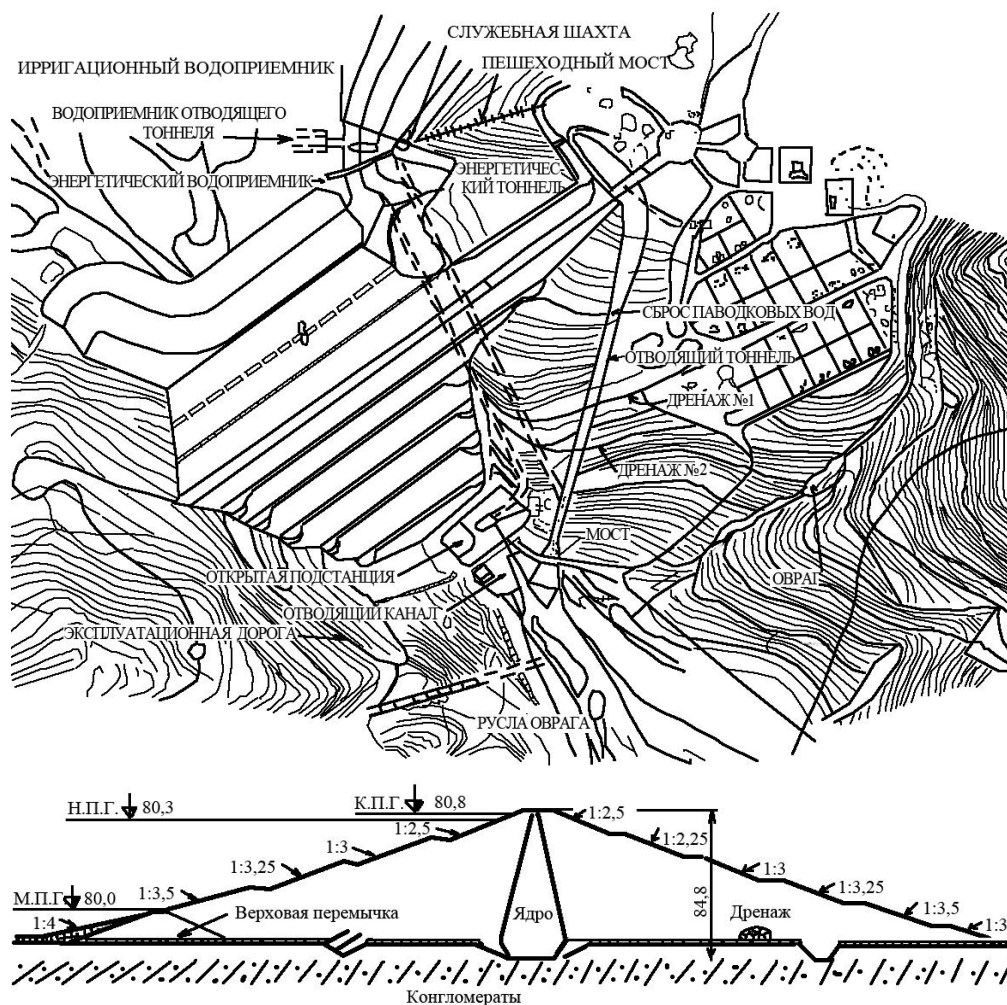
План узла и поперечный разрез плотины Сионского водохранилища
